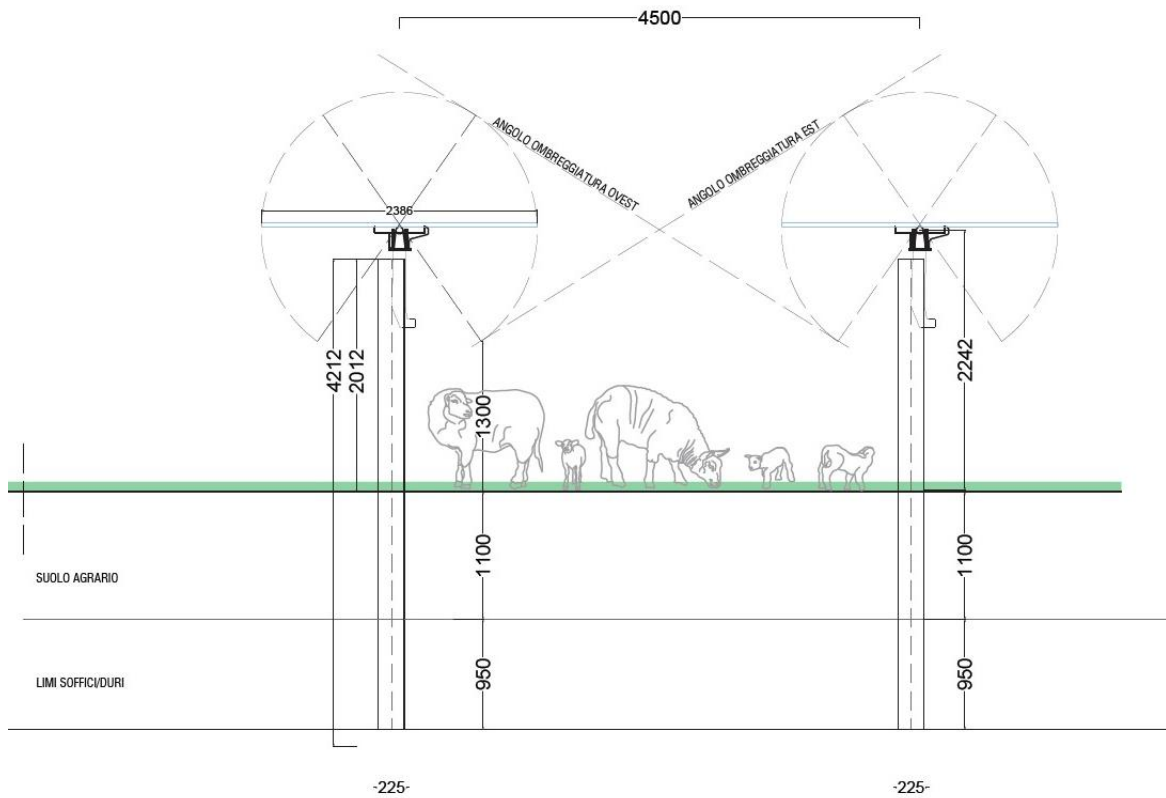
Sezione trasversale tracker in area ad attività zootecnica
